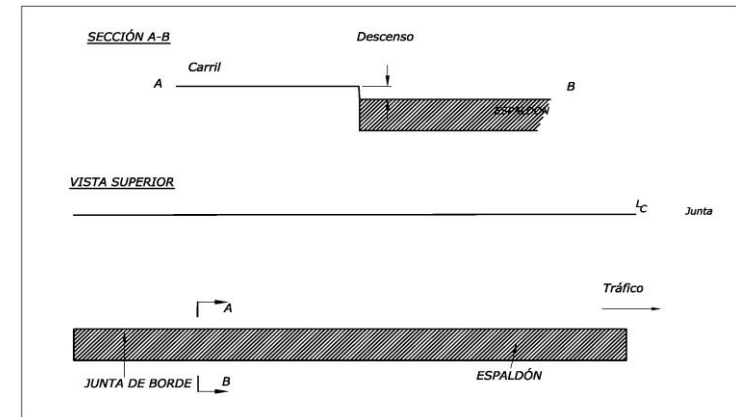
Esquema Escalonamiento entre Calzada y Espaldón - Pavimento Rígido
